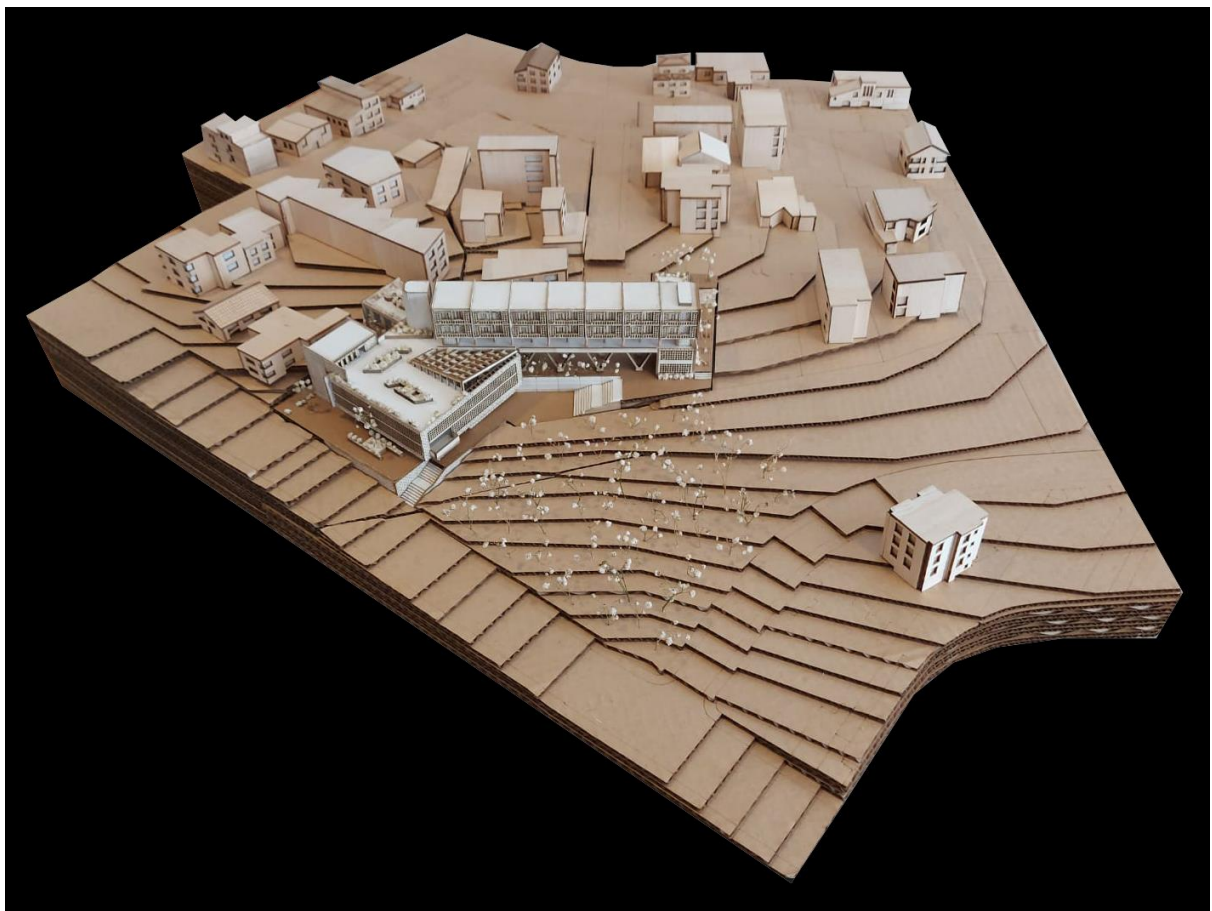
Maqueta escala 1:500 - vista 1. Por: Elaboración propia.
